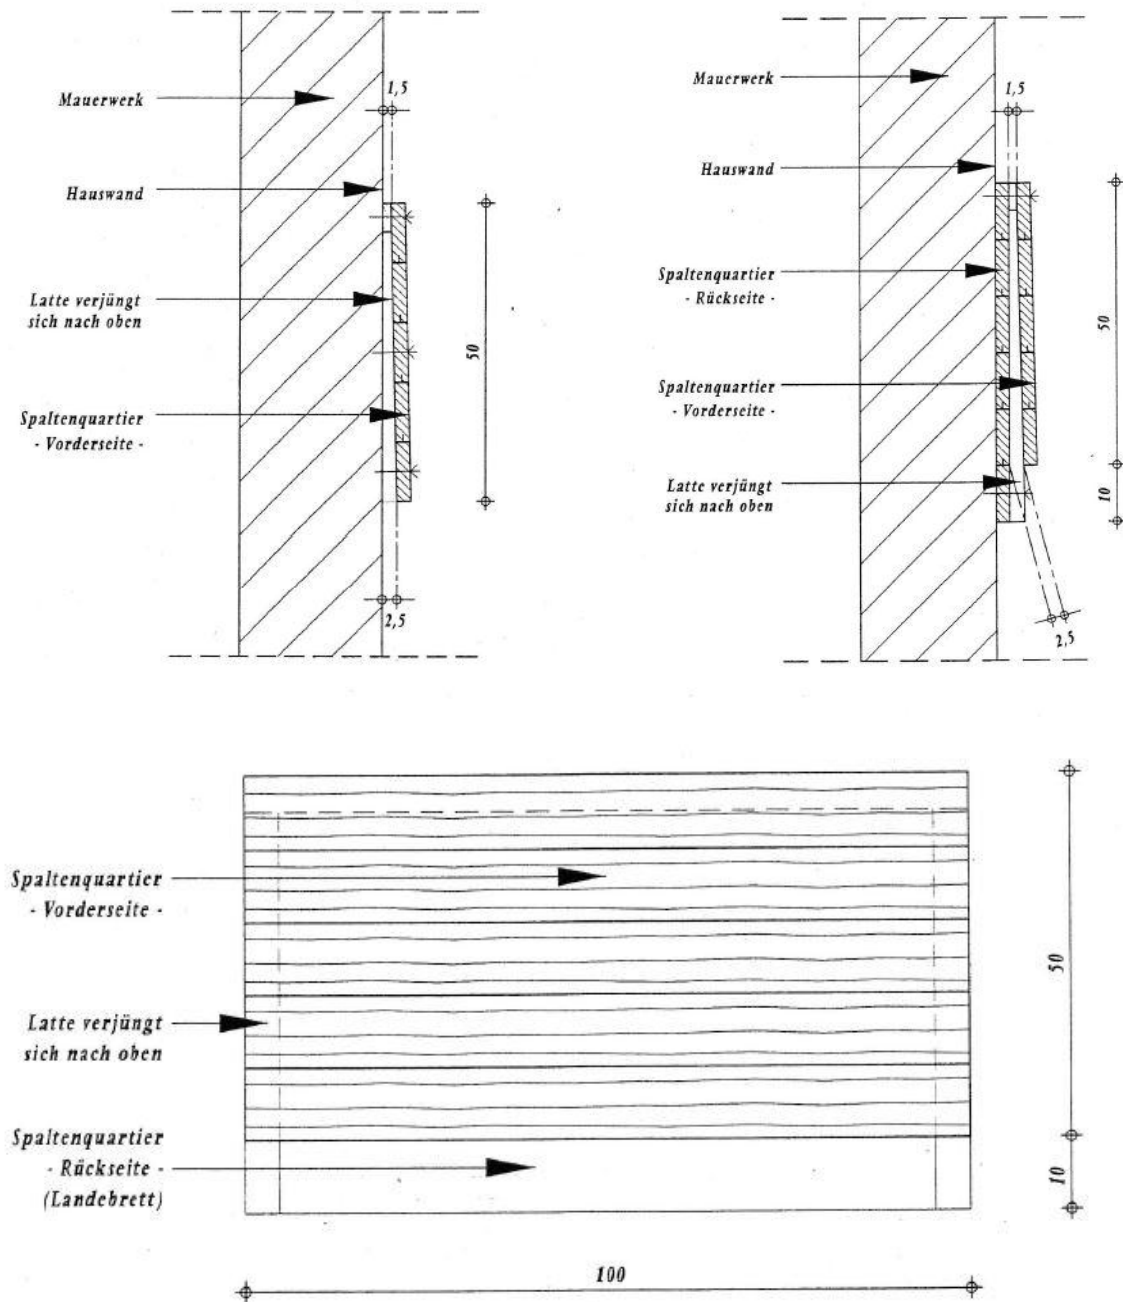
Installationsbeispiel für Fledermausbretter, die an Fassaden angebracht werden (aus DIETZ & WEBER 2000). Systemschnitt eines einfachen Fledermausbrettes ohne Rückwand, was direkt an die Fassade angebracht wird (oben links). Doppelseitiges Fledermausbrett mit Rückwand (oben rechts). Ansicht eines Fledermausbrettes (unten).
